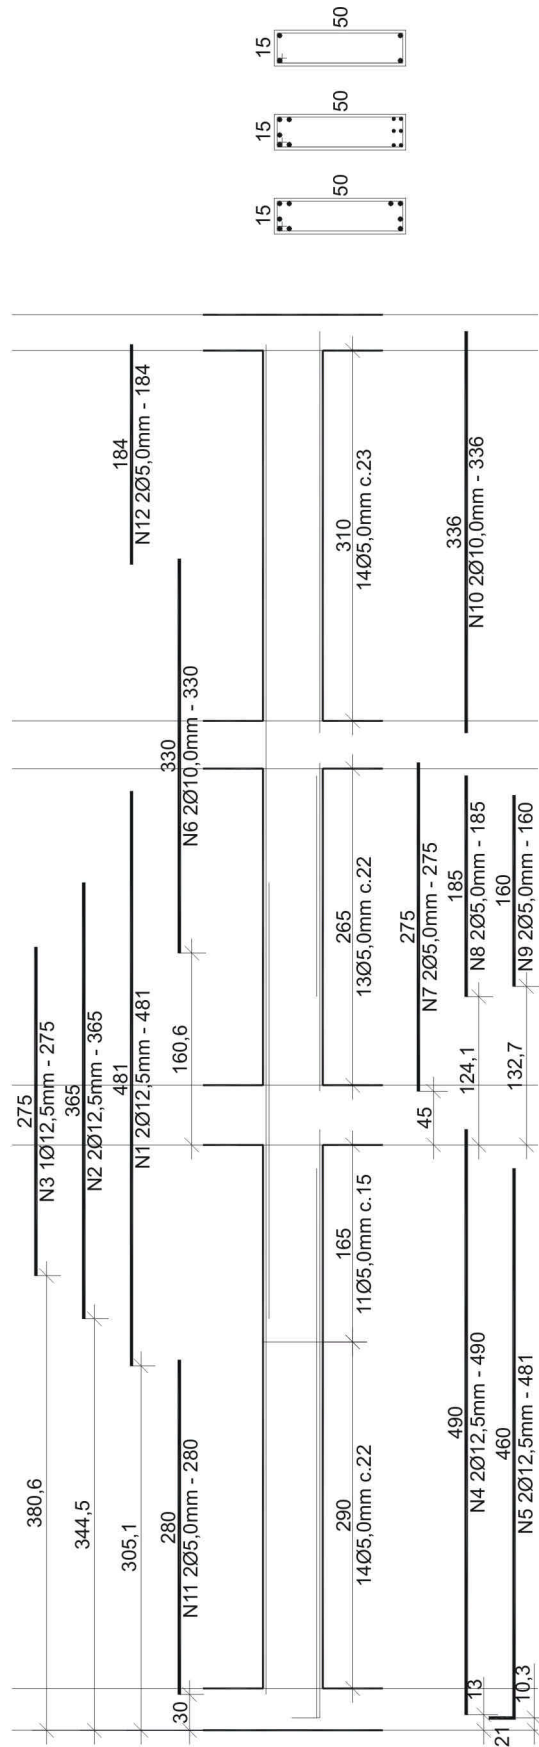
Detalhamento Viga 04.4, realizado pelo VigaCalc.
